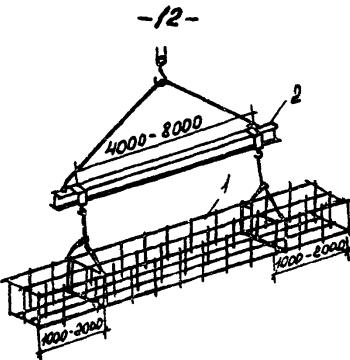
Схема монтажа арматурного блока ленточного фундамента, фундаментного блока и др.: 1- армоблок; 2- траверса
